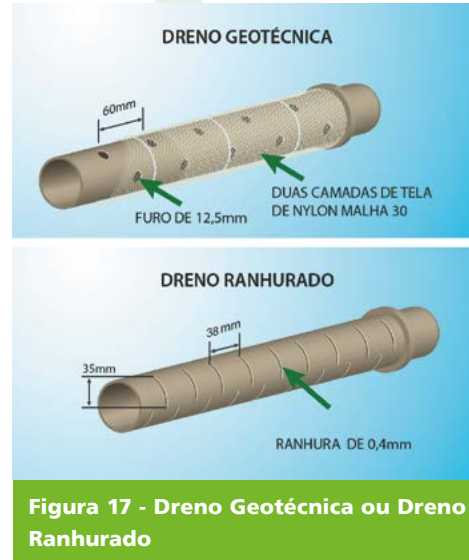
Dreno Geotécnica ou Dreno Ranhurado
